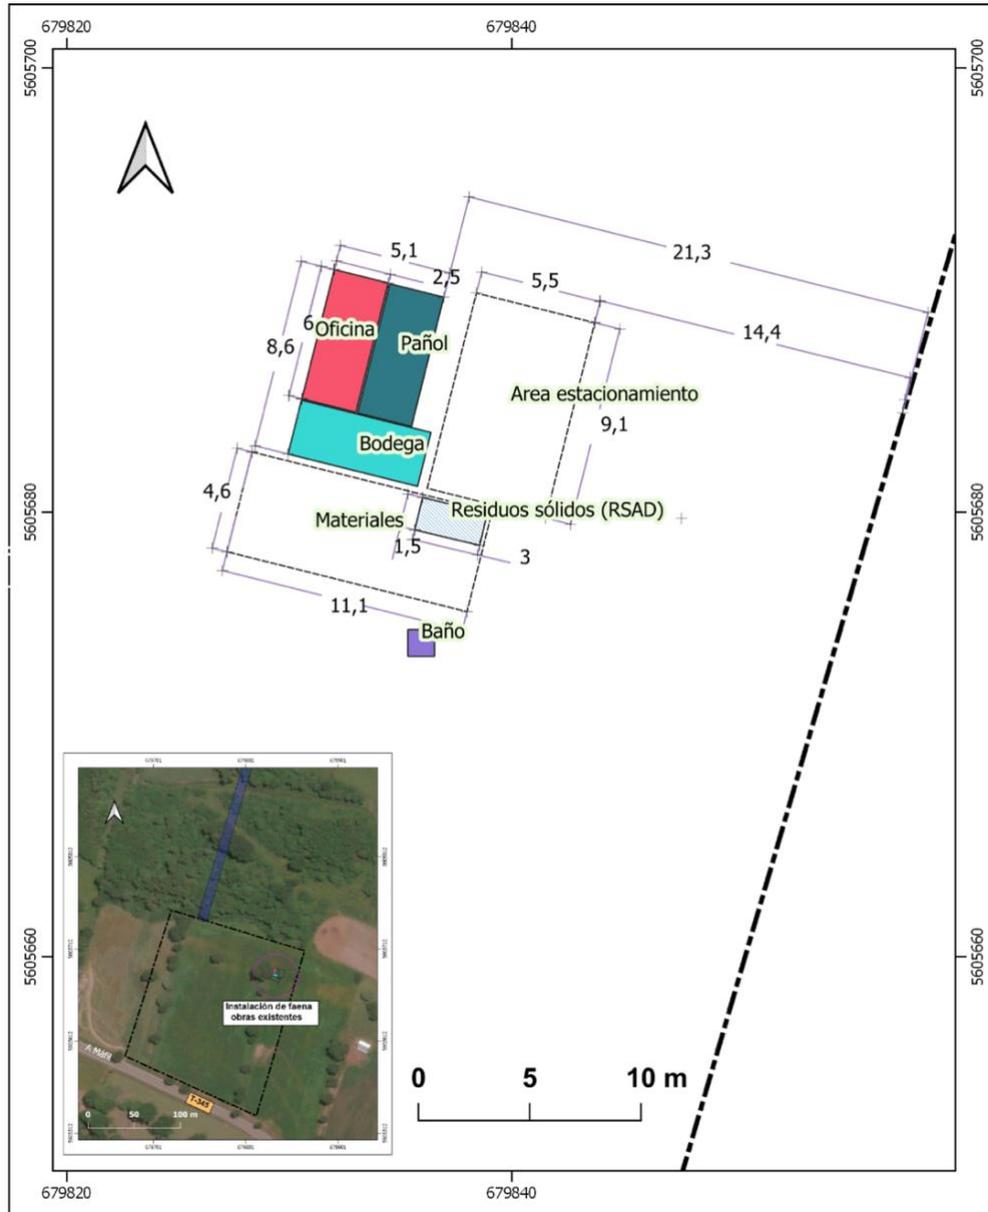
Instalación faenas etapa construcción obras existentes.
